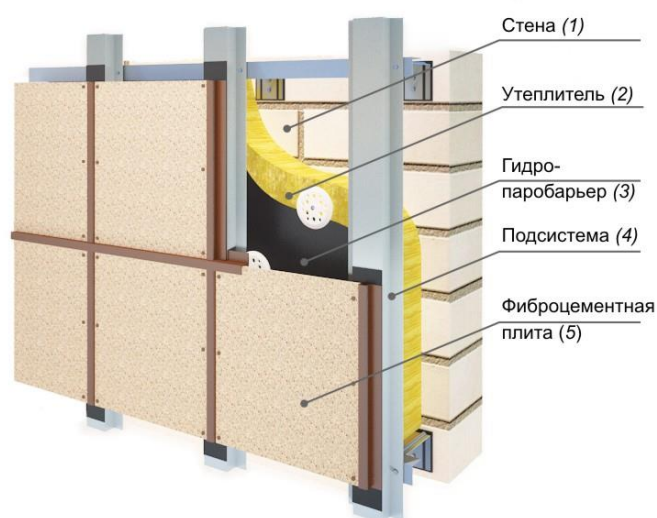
Устройство фиброцементного вентилируемого фасада
